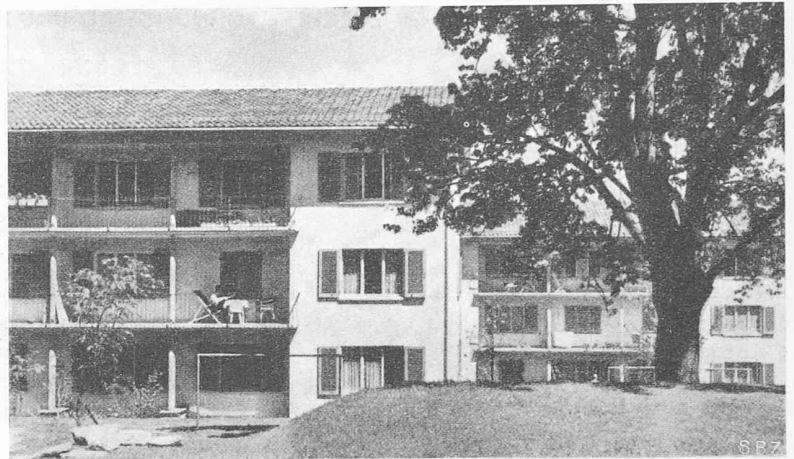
(Westseite) und Bild 4 (Grundrisse 1:300) der dreigeschossigen Mehrfamilienhäuser an der Butzenstrasse in Zürich 2, erbaut 1945. Arch. M. ZOLLINGER
